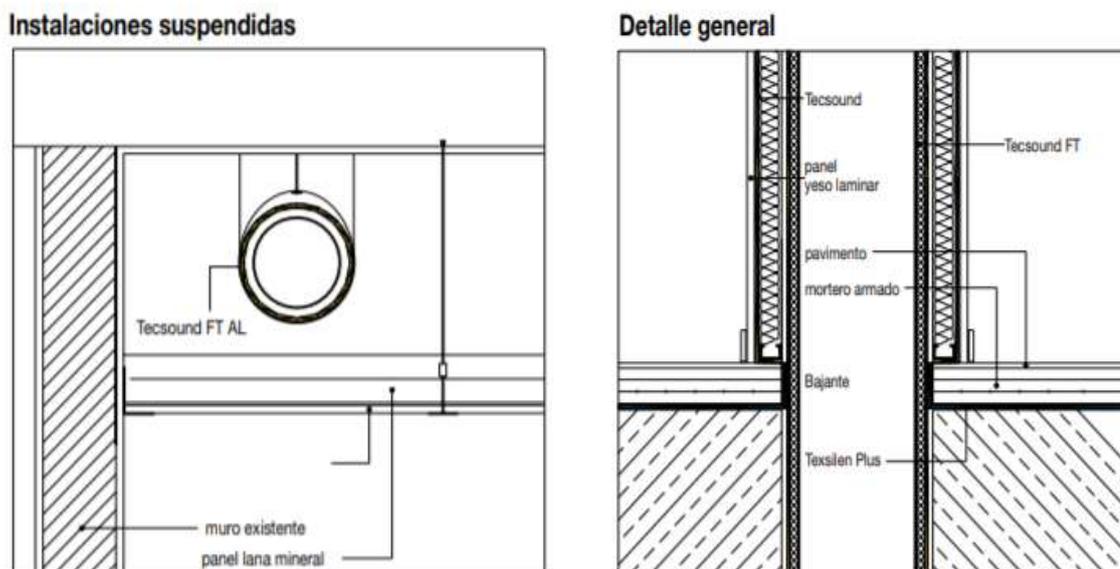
Detalles del Sistema de aislante Acústico para tuberías bajantes
